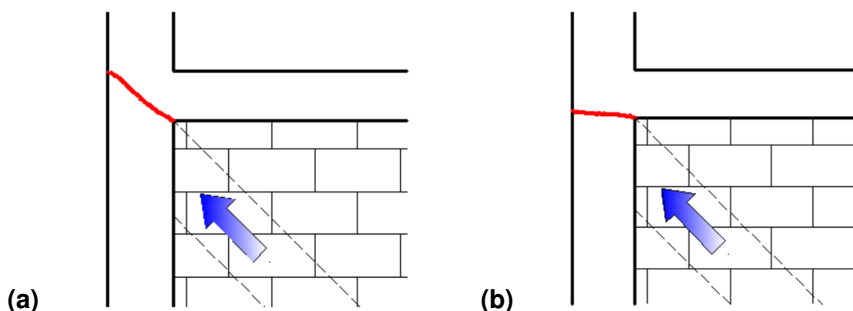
Representación esquemática del mecanismo de rotura en un nudo viga-columna debido a las fuerzas cortantes provenientes de los muros: a) Fisura diagonal en el nudo; b) Fisura casi horizontal en la junta nudo-columna.
